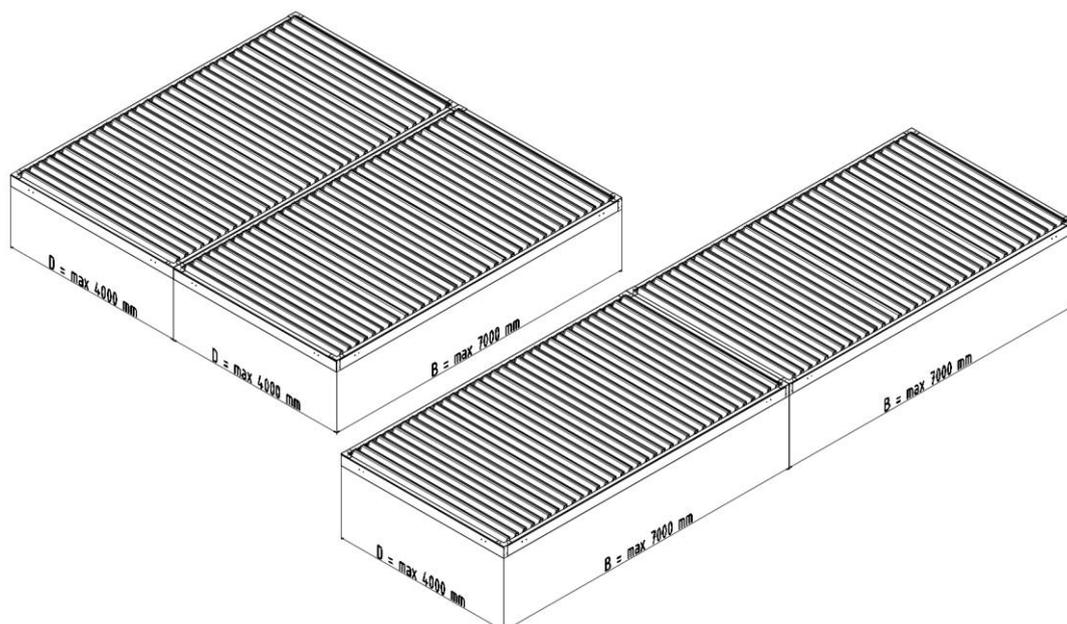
Pergola SB400PRO R liée modulaire linéaire – par les barres longitudinales ou transversales
